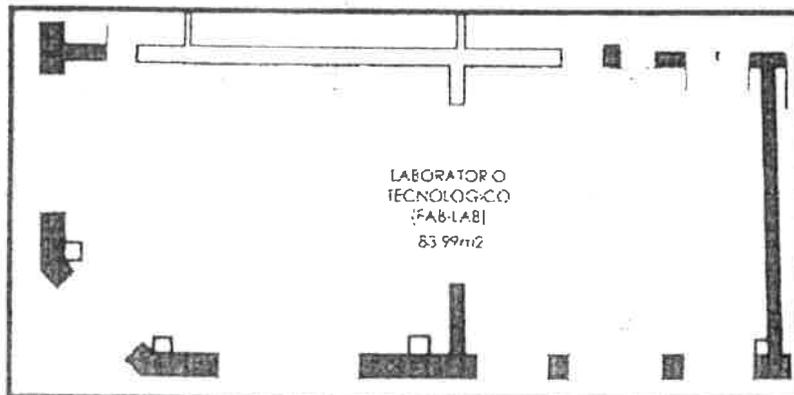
Planta de distribución de primer nivel, donde se muestra el ala oeste. Fuente: GCH/AMDC
